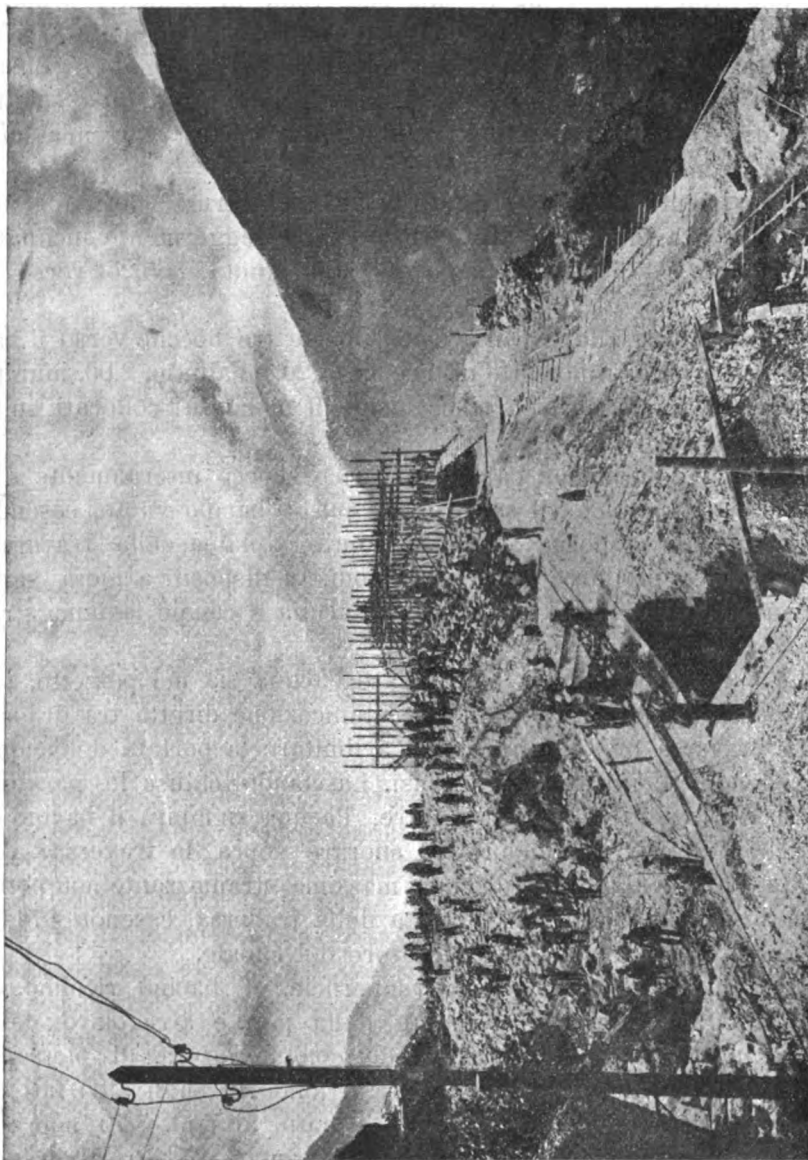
Bacino di calma con muri in cemento armato (in costruzione).
